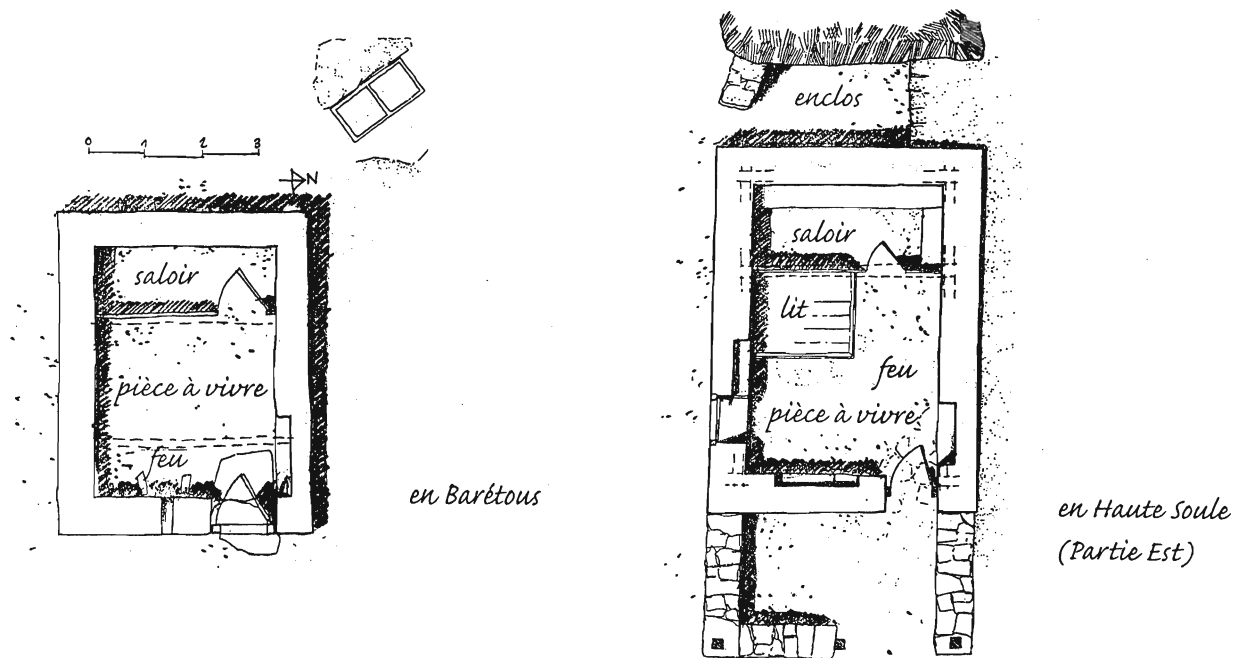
Plans des cabanes de bergers traditionnelles en Barétous et Haute-Soule (97).
